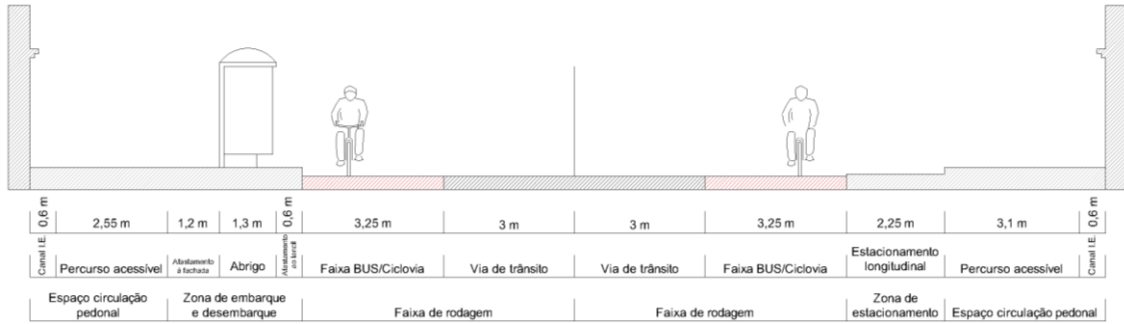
SECÇÃO PROPOSTA D-D'
